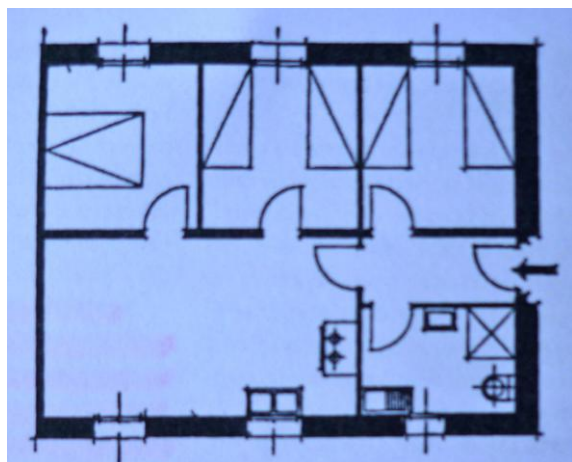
Planta de vivienda mínima; fotografía procedente de Ana Isabel, Pereira Gil, *De la casa al piso. La vivienda española (1939-1975) y su reflejo en un ámbito concreto de actuación: Langreo
